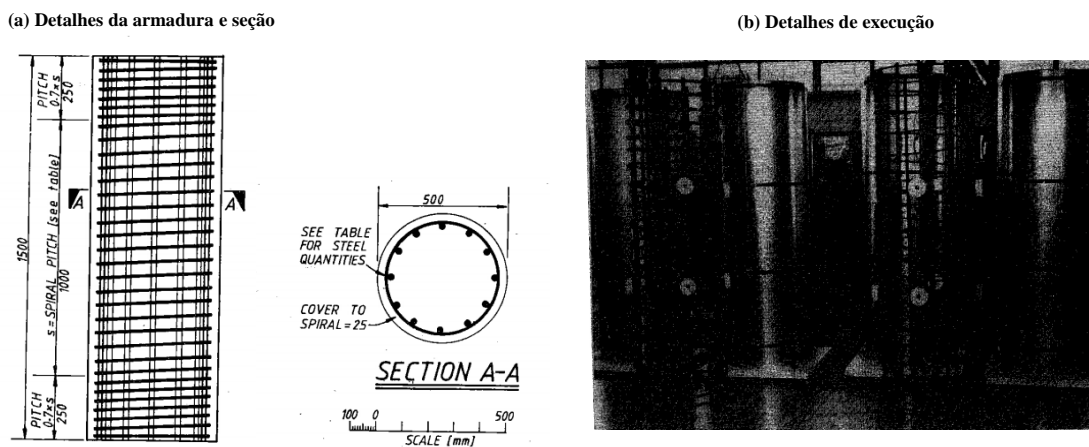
Detalhes de armaduras, seção e execução dos pilares de Mander (Fonte: Mander, 1984)
